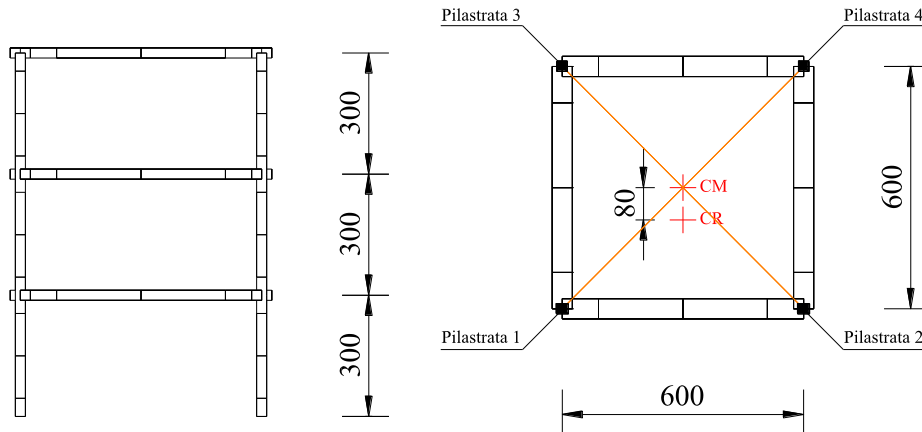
Prospetto e pianta della struttura con suddivisione in elementi finiti.
